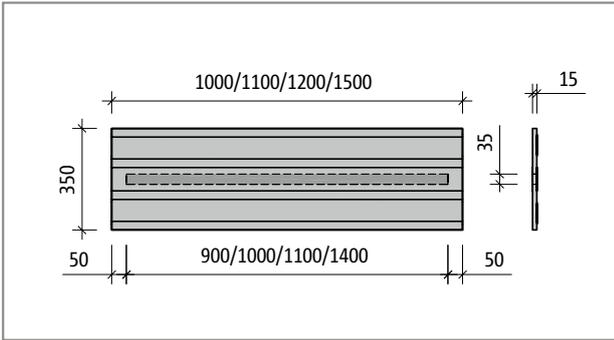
Schöck Tronsole® Typ B-V1-L...-B350: Produktgrundriss
